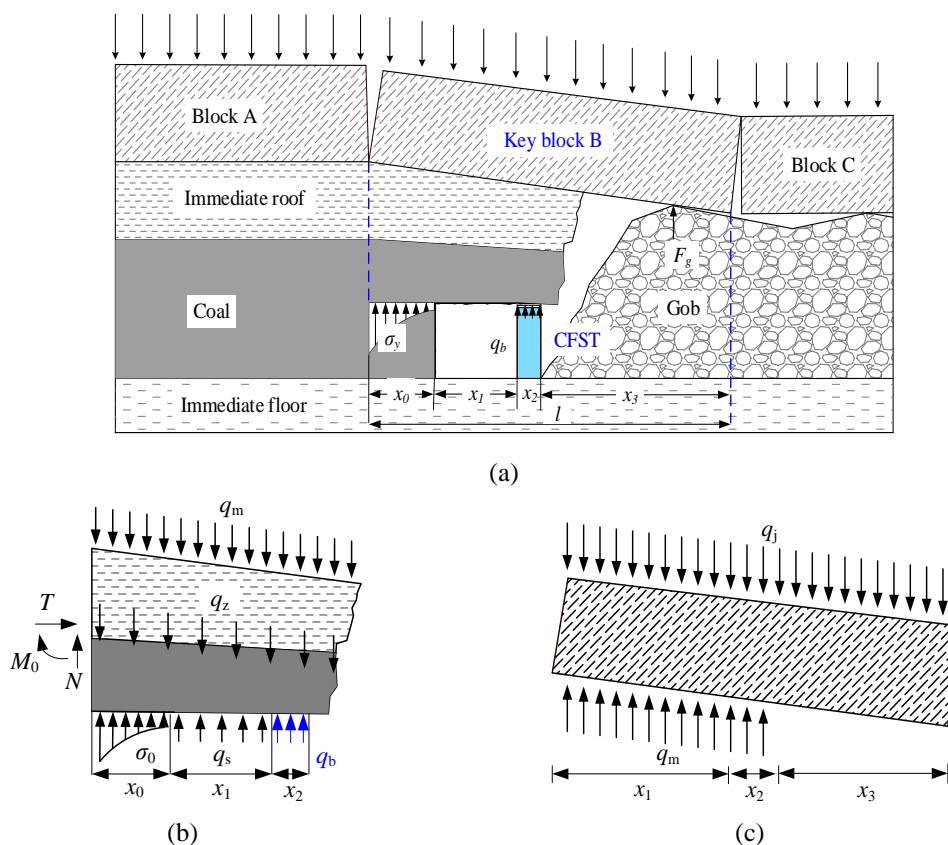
Механическая модель выработки, поддерживаемой за лавой при отработке пластов КМЗ с обрушением и выпуском угля. (а) Механическая модель; (б) непосредственная кровля; (в) основная кровля
